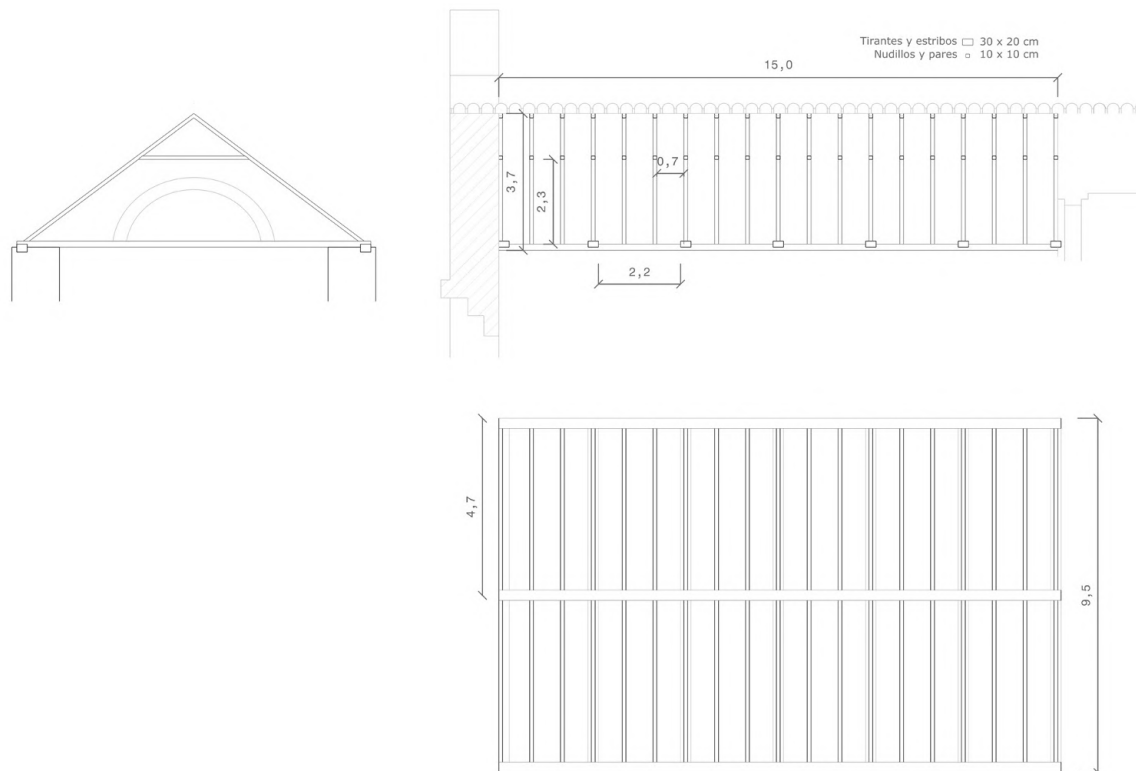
Planimetría detallada de la cubierta de madera de San Isidoro de Ávila con medidas.
